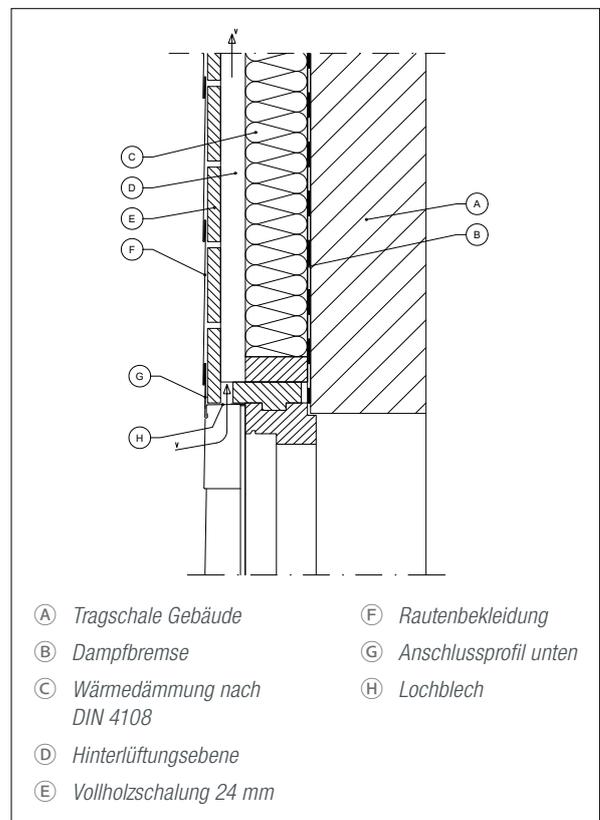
Rautensystem Fassadenanschluss an Fenstersturz
